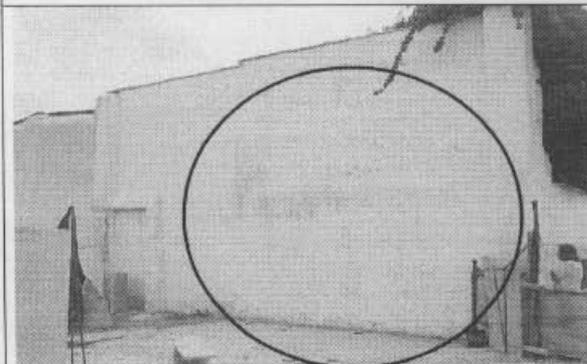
Muro culata correspondiente al costado occidental, con fisuras superficiales evidentes.
